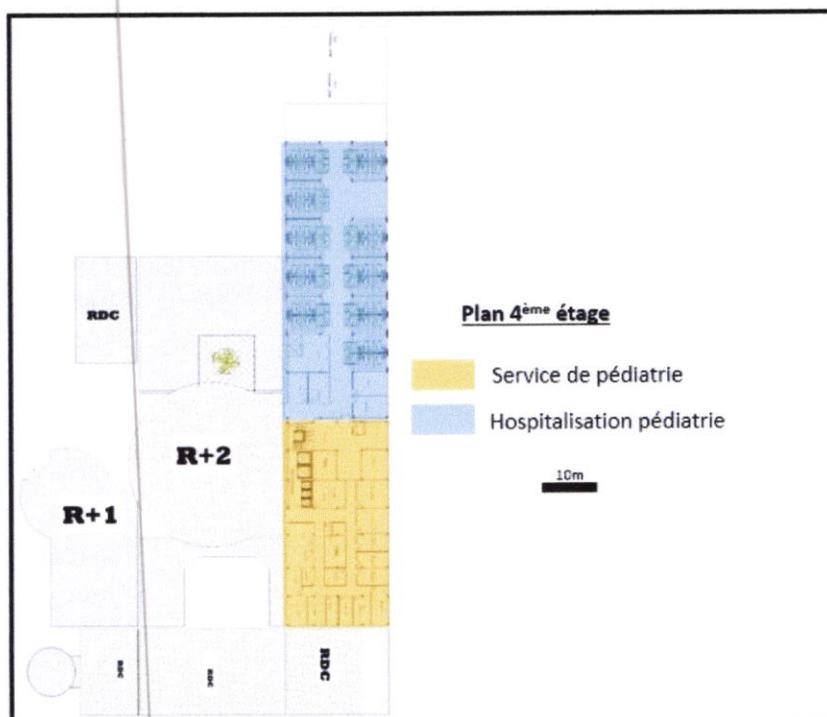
Plan 4<sup>ème</sup> étage-Agencement des unités fonctionnelles Source : Auteurs.
